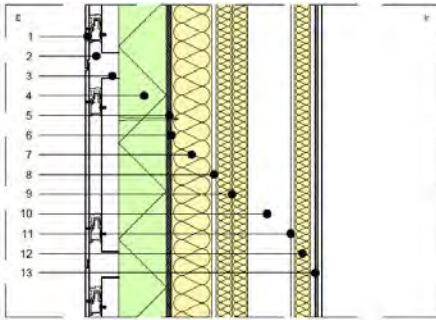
C.V. - Parete perimetrale, restituzione grafica Bernardi Lorenzo
